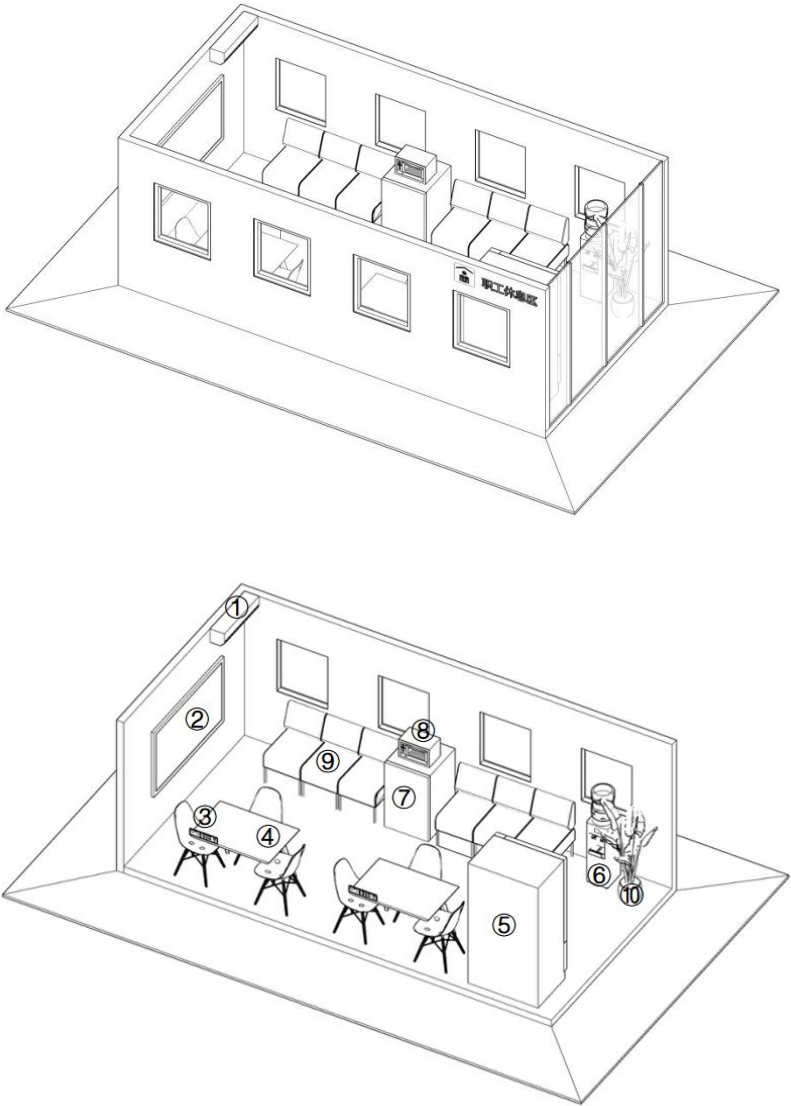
飞行区共享休息区基本单元剖面示意图（单位：mm）
